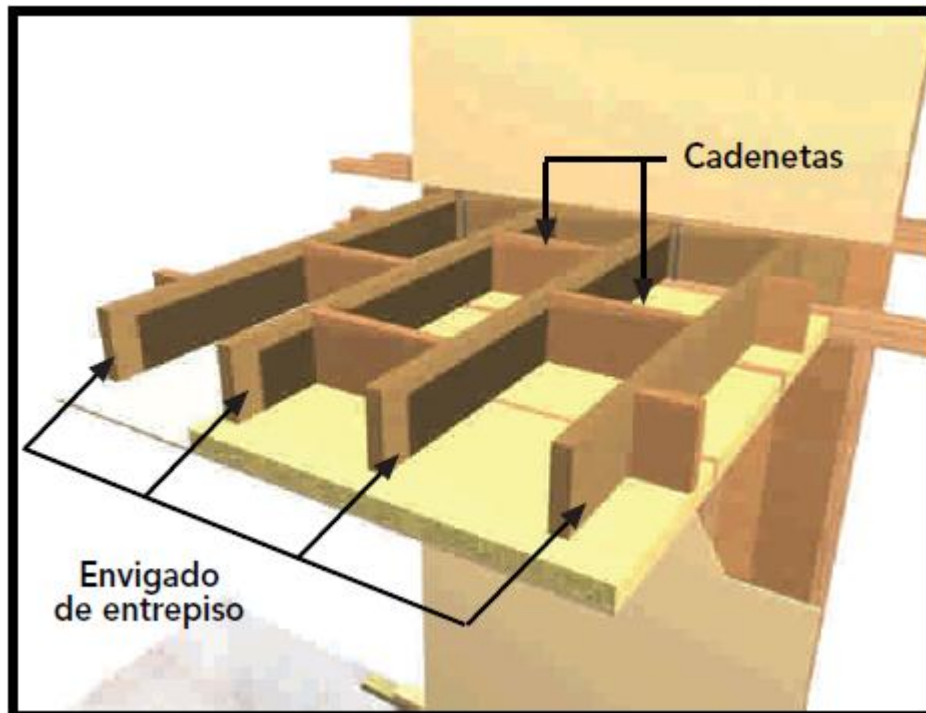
Piezas de madera dispuestas en forma normal, de sección similar a las vigas.
